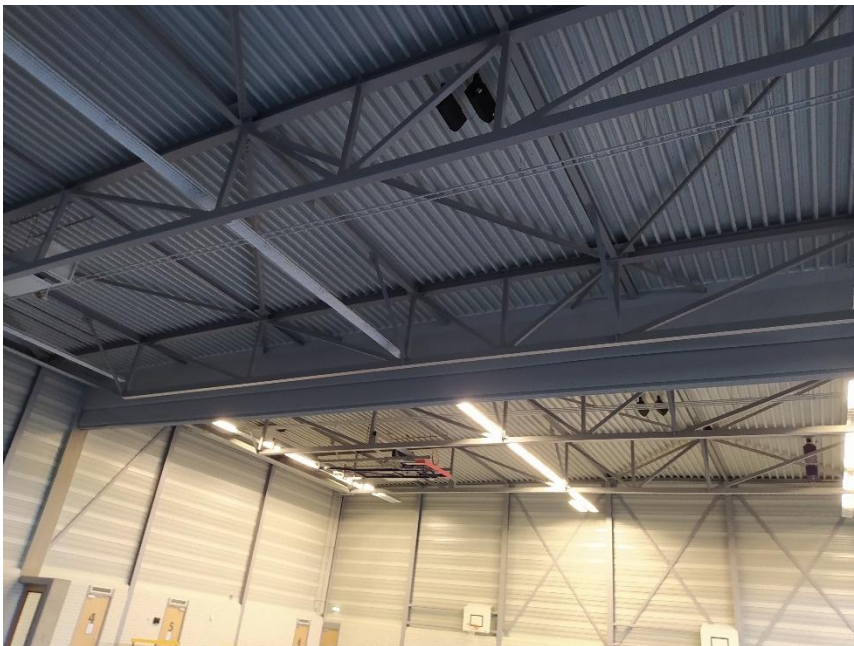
Overzichtsfoto 2 van armaturen in sportzalen Sporthal de Zeine
